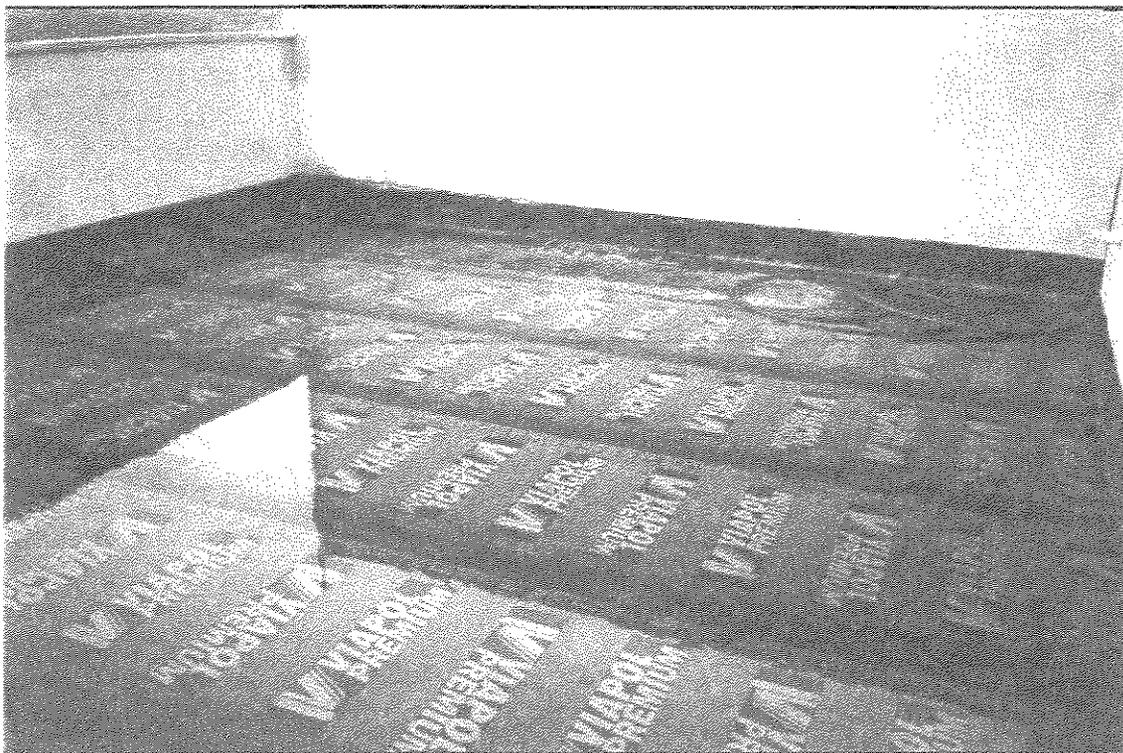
Impermeabilização das Lajes Externas com Manta Asfáltica
